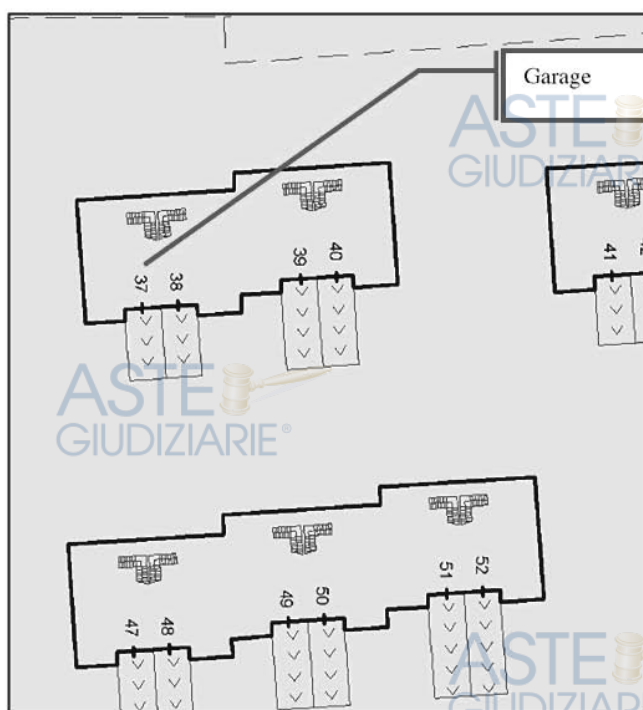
Visualizzazione dell'elaborato planimetrico del piano primo sottostrada- individuazione del sub. 37
